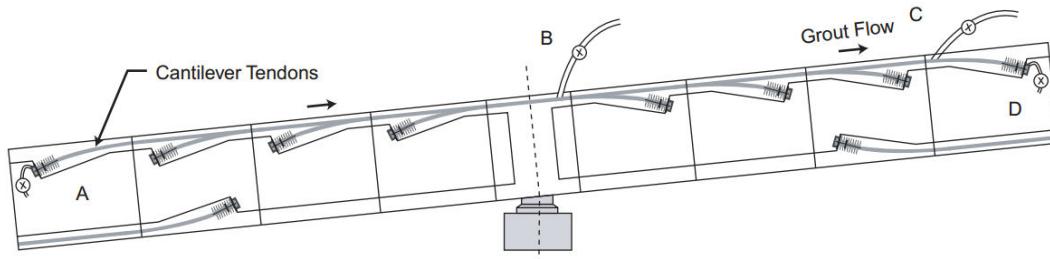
Detalles del grouting para un sistema de ducto de un cajón celular, losa con aberturas o sólida.
